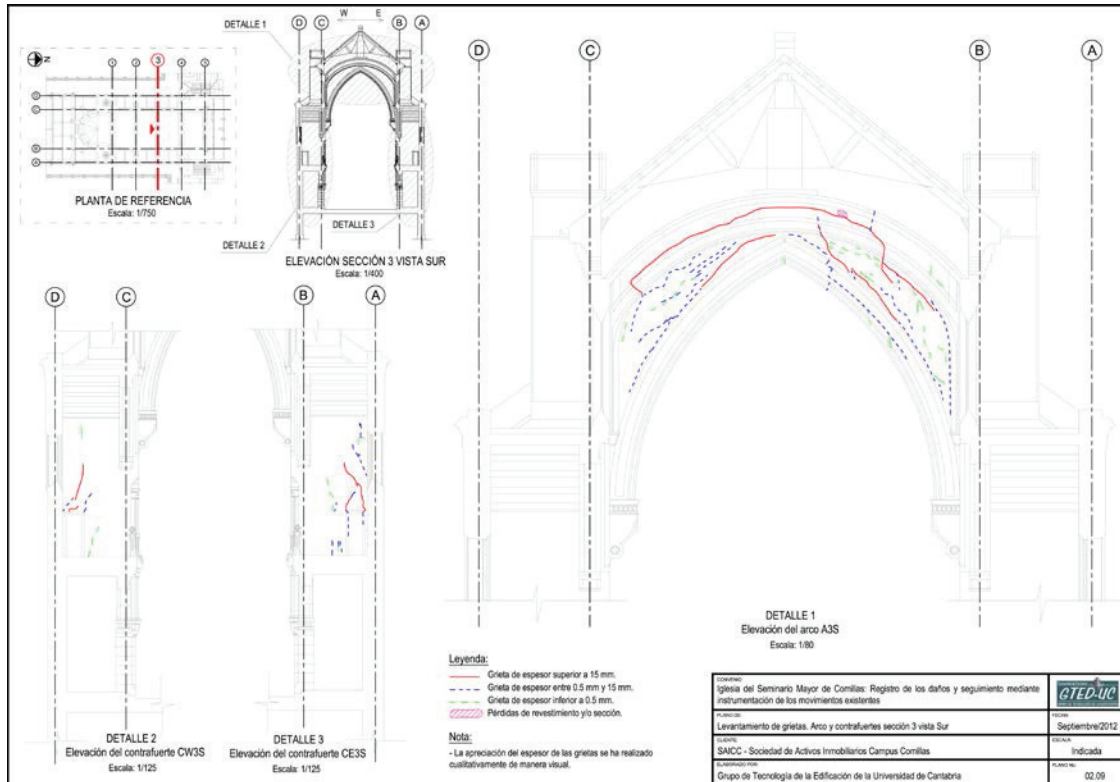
Ejemplo de plano de levantamiento de grietas del arco y contrafuertes de la sección 3 vista Sur.
